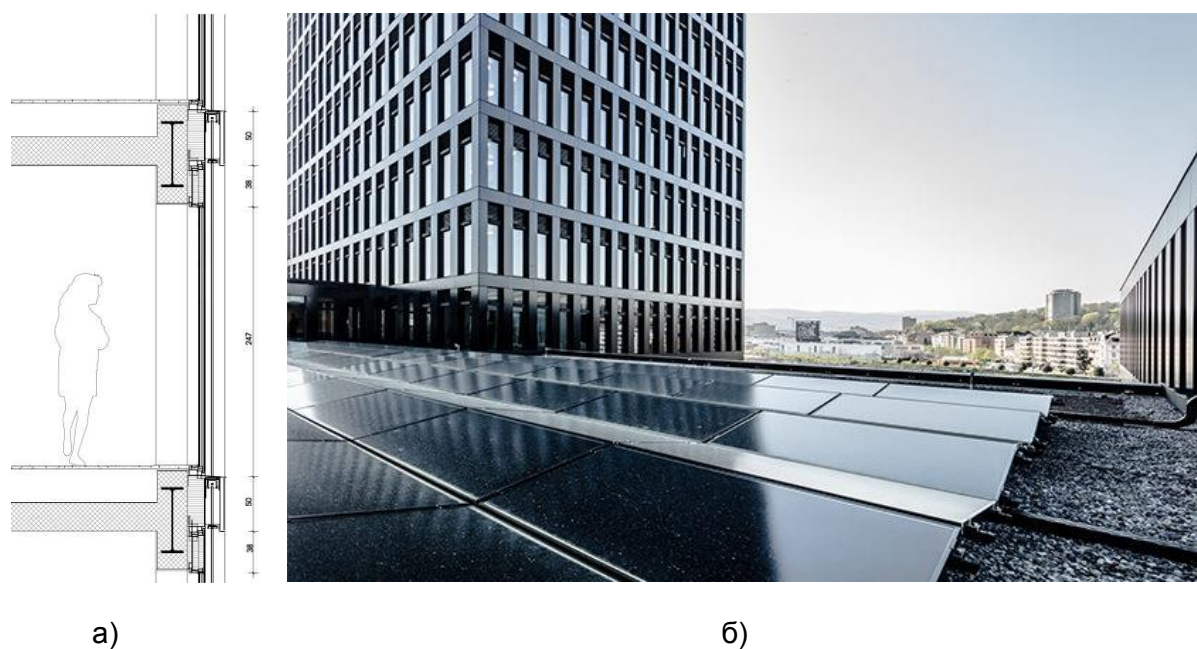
Инженерно-конструктивные решения общественного здания «Grosspeter Tower»: а) узел деталей фасада; б) фотоэлектрические модули на крыше
